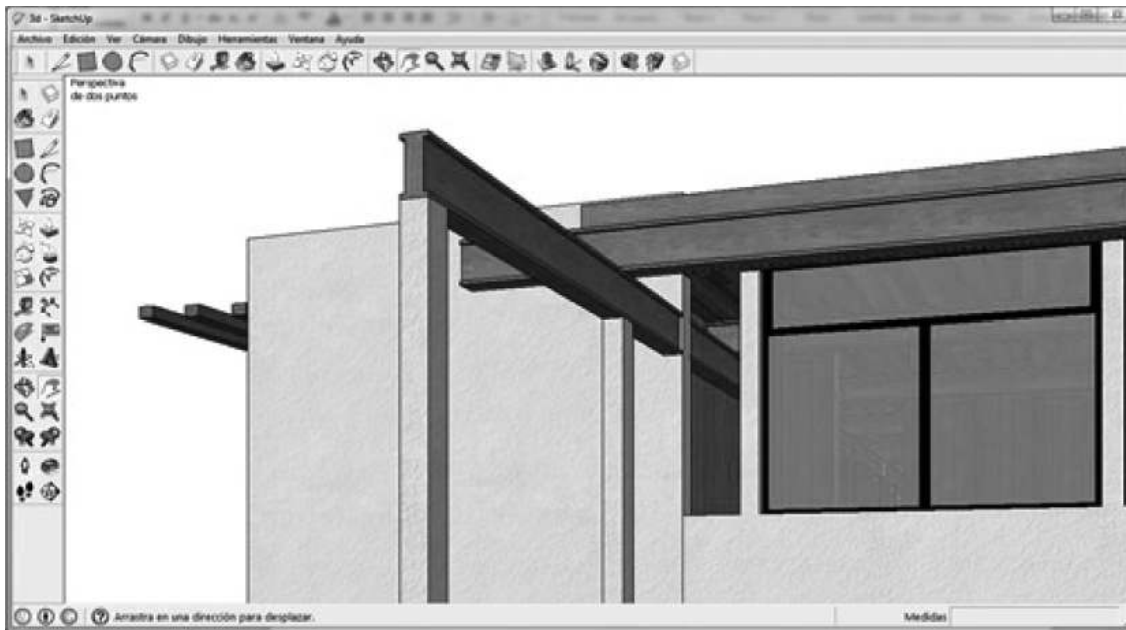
SKETCHUP / COMPARACIÓN DE LOS DETALLES CON LA FOTOGRAFÍA / ELABORACIÓN PROPIA.
